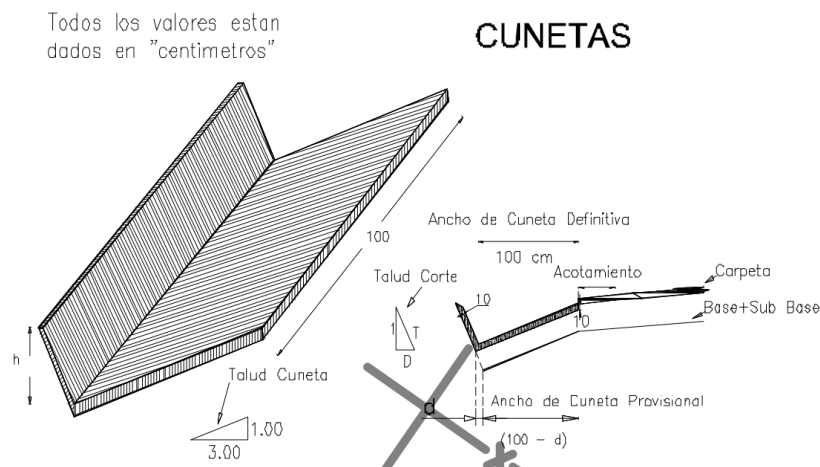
Detalle de las cunetas a construirse, en el proyecto.
